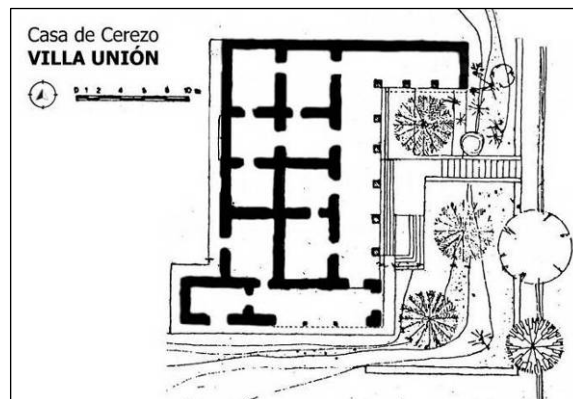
Plano de la casa del Sr. Cerezo (modificado de Canepuccia et al. 1976)
